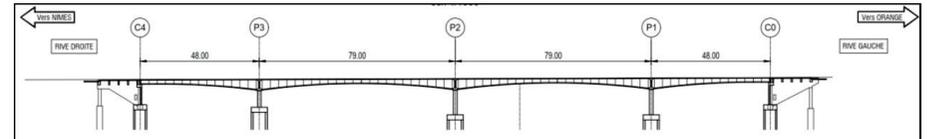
Coupe longitudinale de l'ouvrage (Arcadis, 2022)
